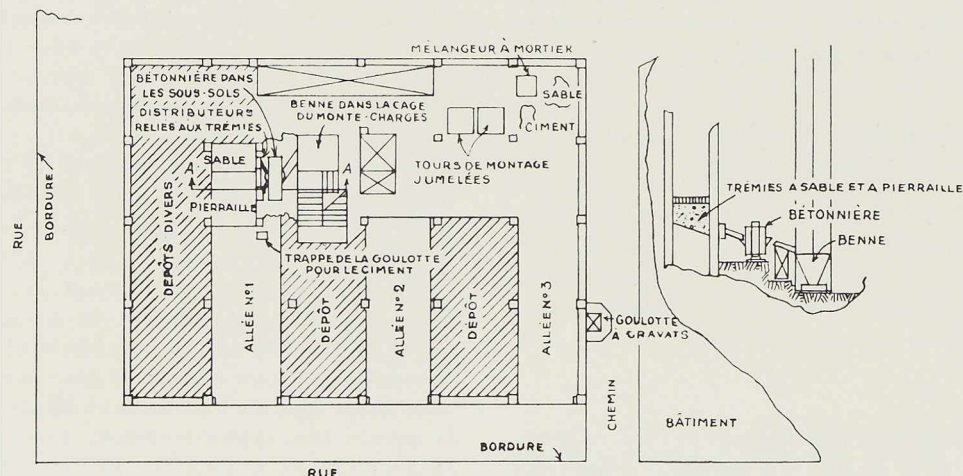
Bâtiment pour bureaux de 38 étages. Vue en plan du premier étage.
